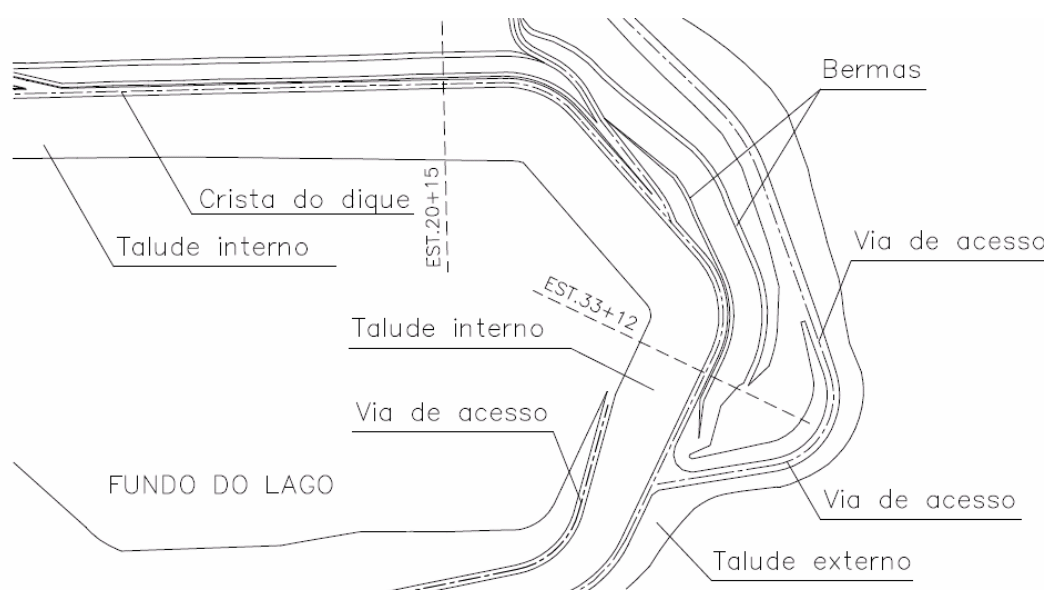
Vista em planta das duas seções instrumentadas (Becker, 2006).
